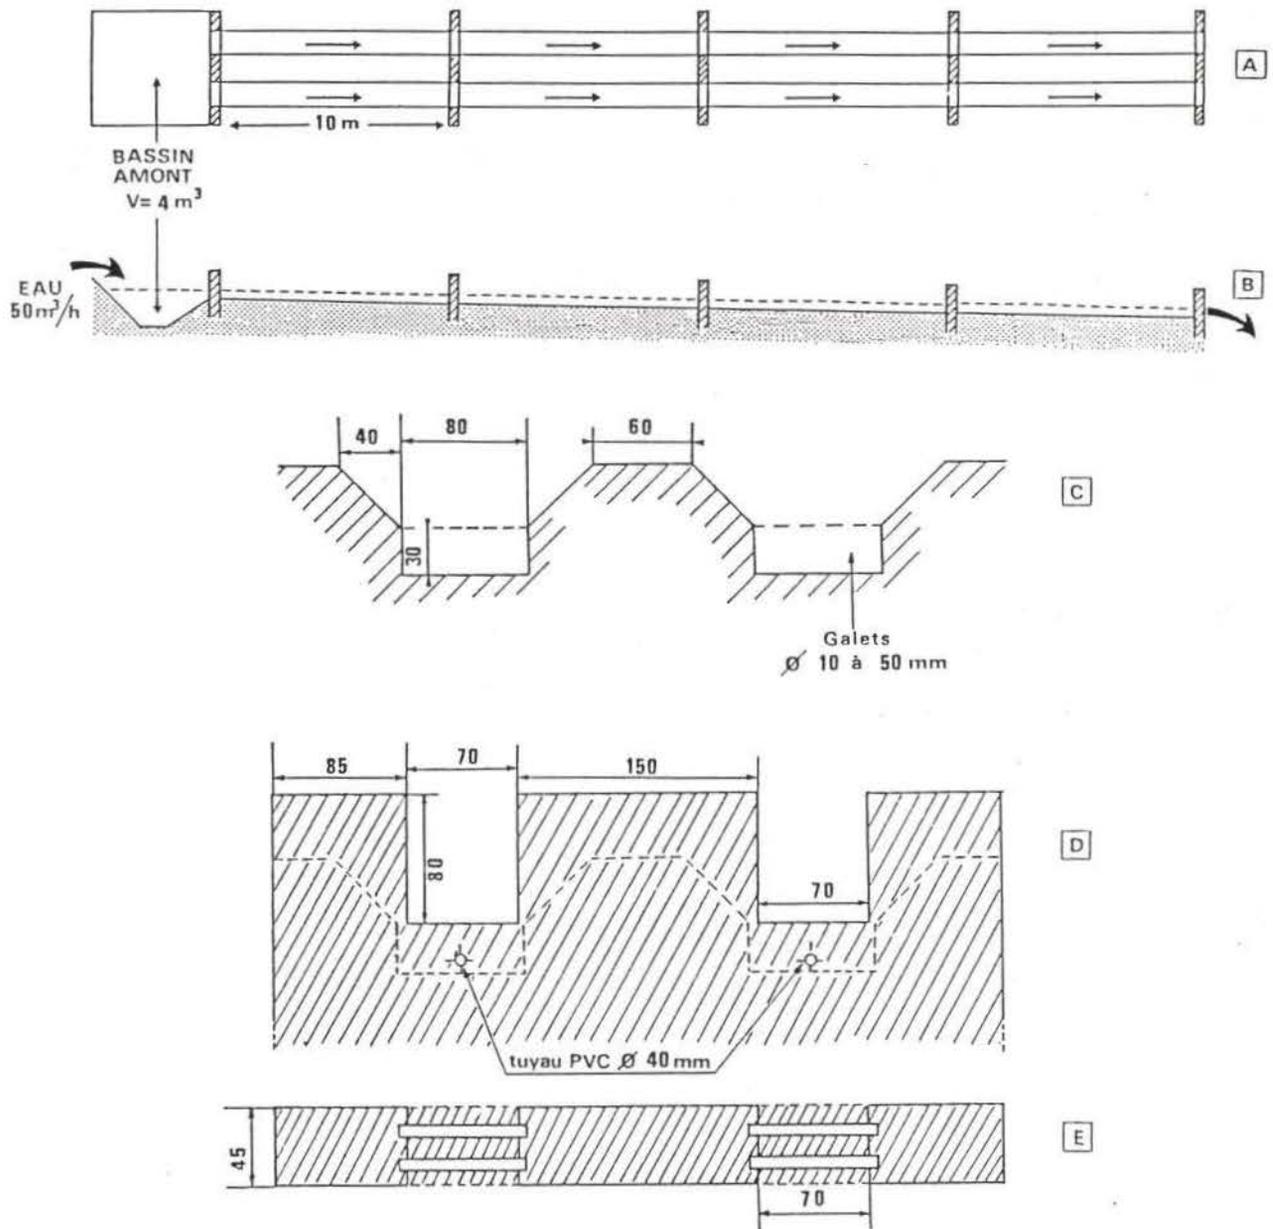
Plan des installations (cotes en cm sauf indications contraires) :
